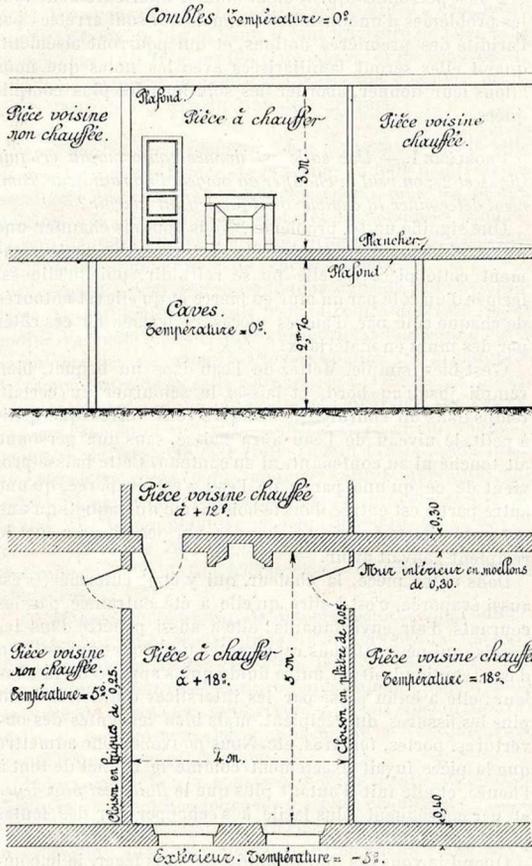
et 2. — Vues en plan et en élévation du local à chauffer.
